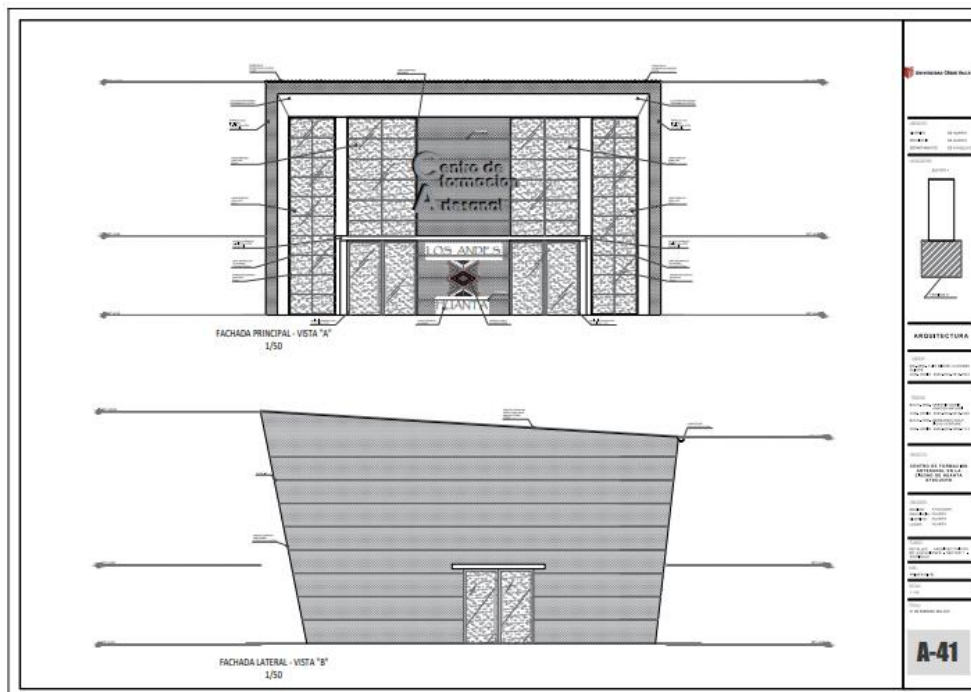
Detalles arquitectónicos por sectores escala 1/50.
